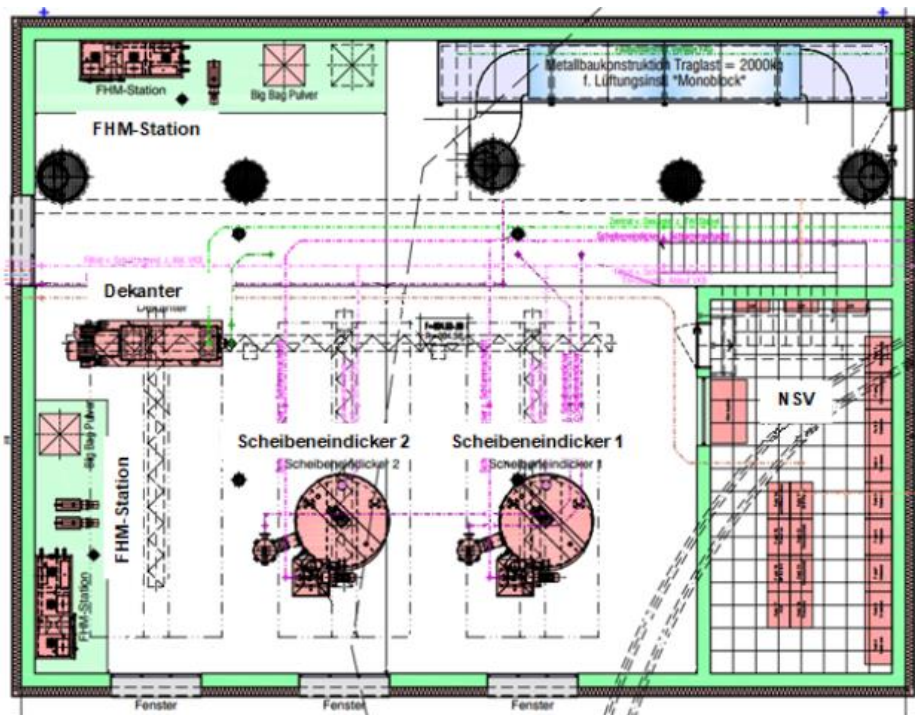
Schema des geplanten Gebäudes - Obergeschoss
